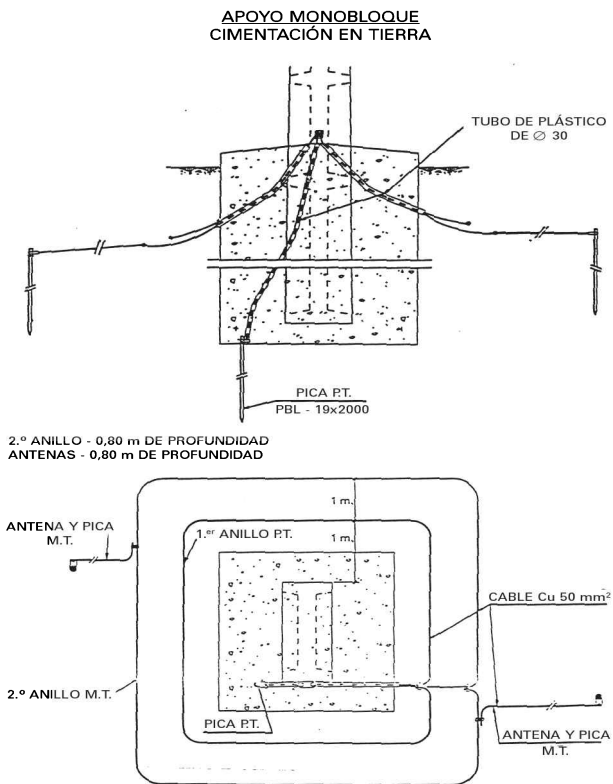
Apoyo monobloque. Cimentación en tierra. Apoyo de hormigón.
